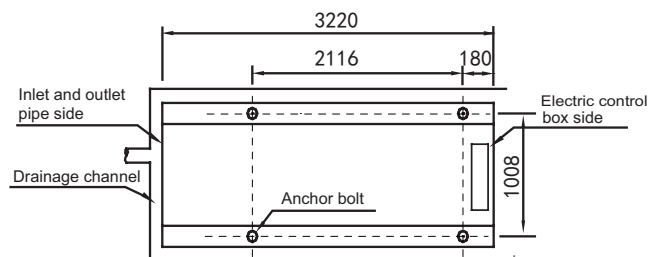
Boven aanzicht van het schema van de installatieafmetingen van KEM-30 DNS3
